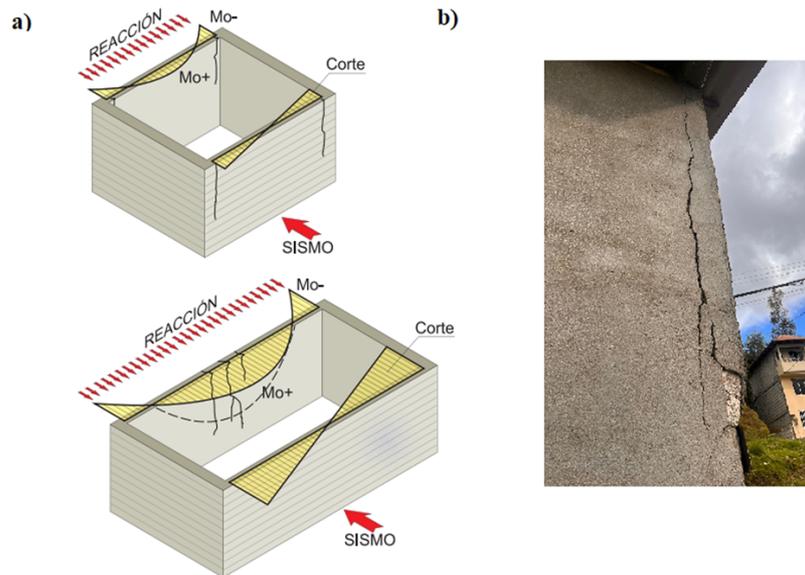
a) Comportamiento del muro frente a un sismo, b) Fisura en muro de distancia 5 m entre columnas, casa #8
